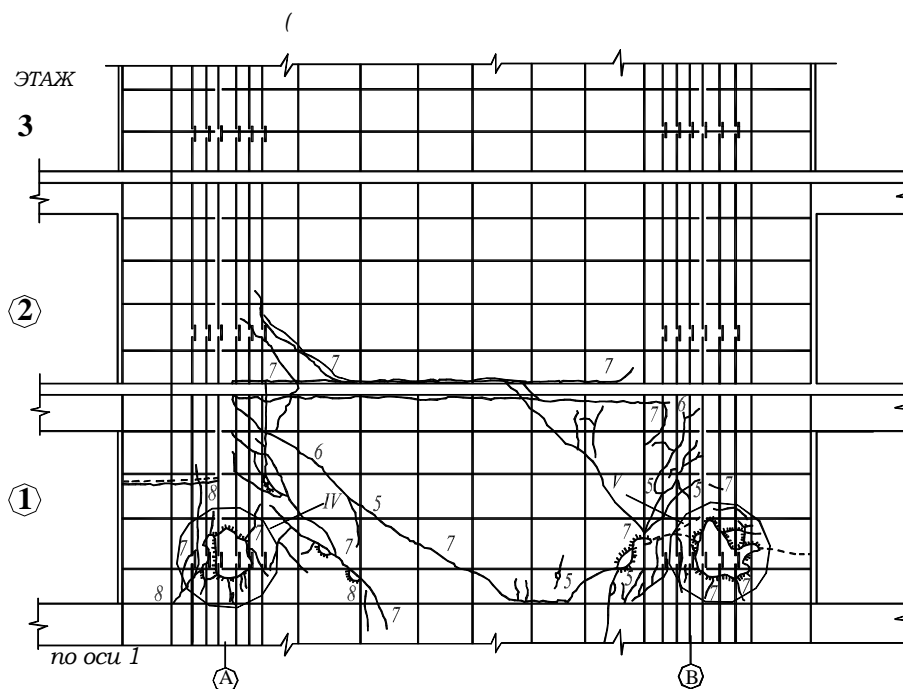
Схема трещинообразования стены фрагмента 1, армированной вертикальными каркасами (вид снаружи).
